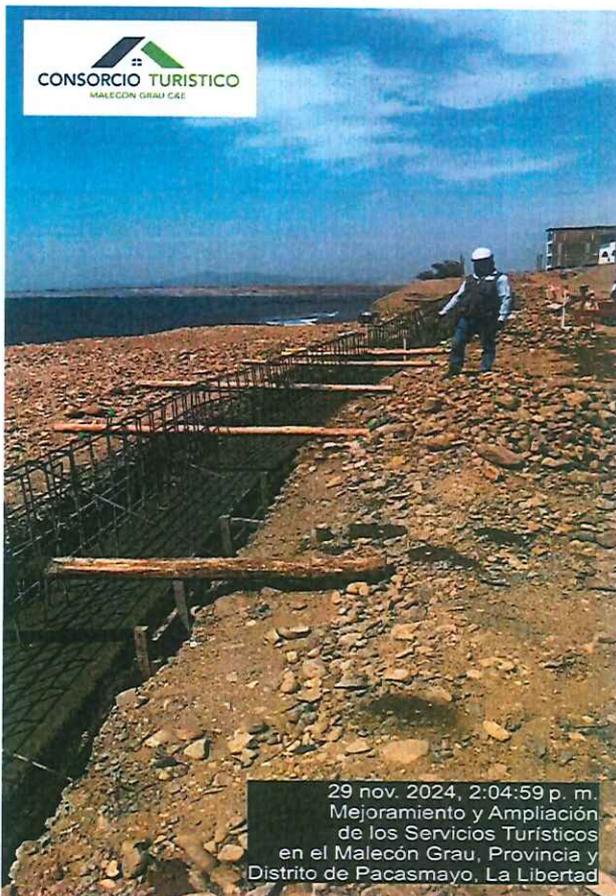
En la vista se aprecia al especialista de estructuras realizando la verificación de la colocación y alineamiento de las armaduras de acero en el sector de los muros de borde conformada por sobrecimientos armados.
